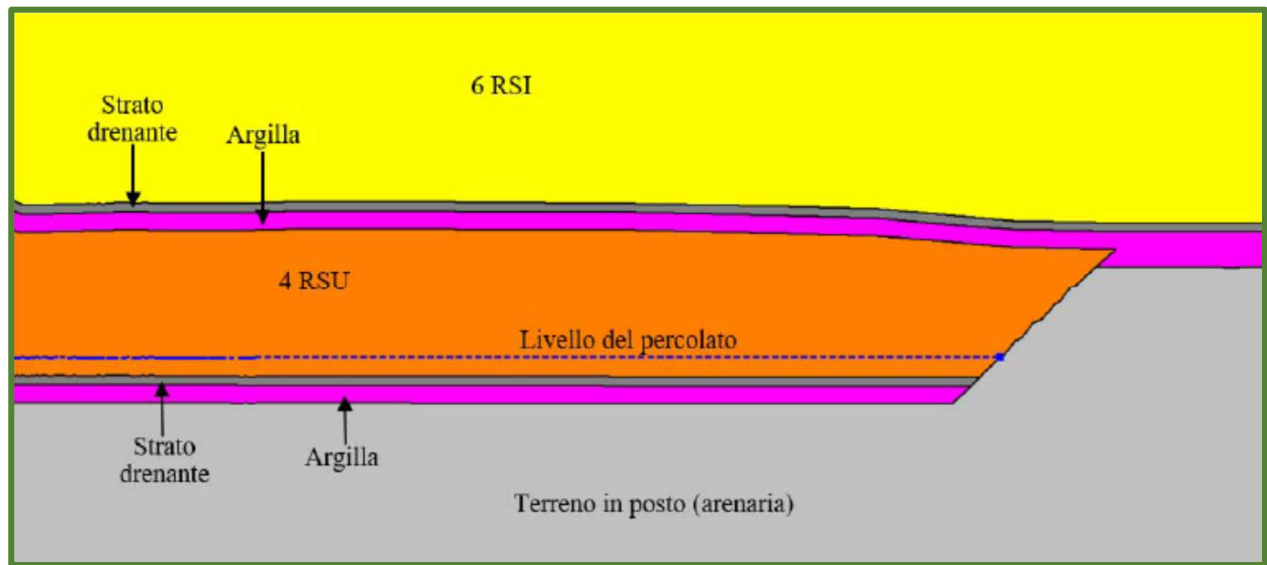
/VI – Sezione A-A' – Sponda sud-ovest - Particolare 2
